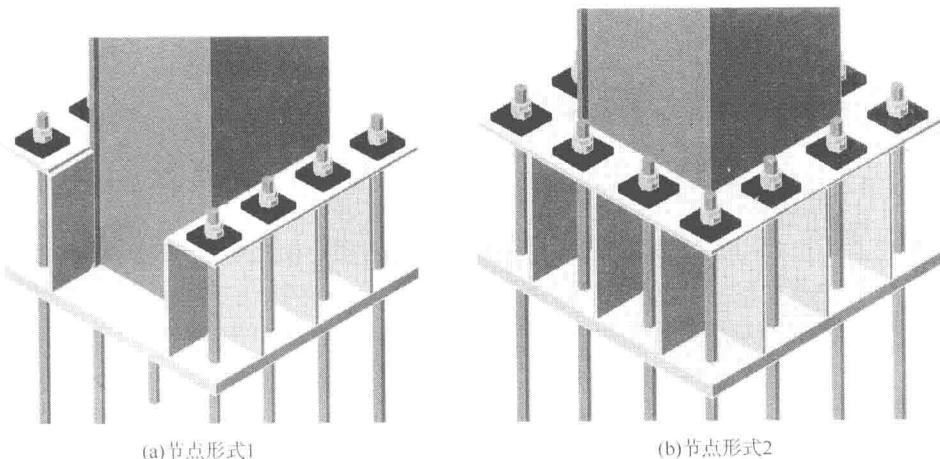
焊接箱型截面柱脚刚接节点形式
